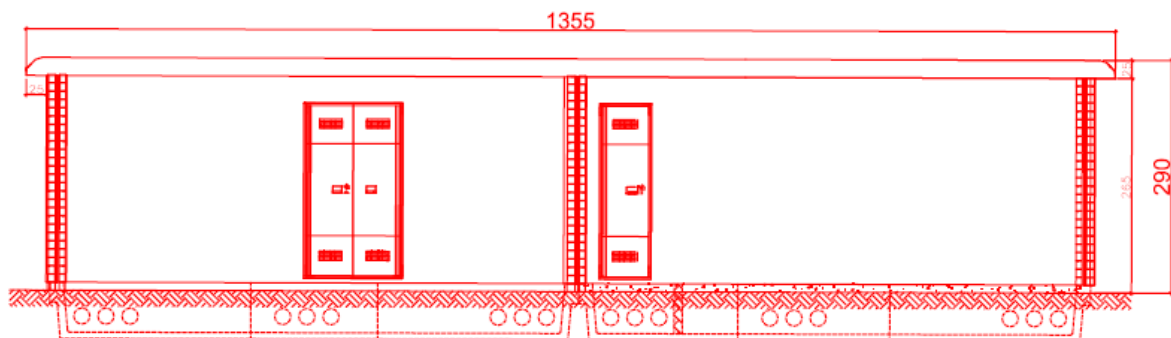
Prospetto longitudinale del fabbricato FAVR nel Progetto di variante
